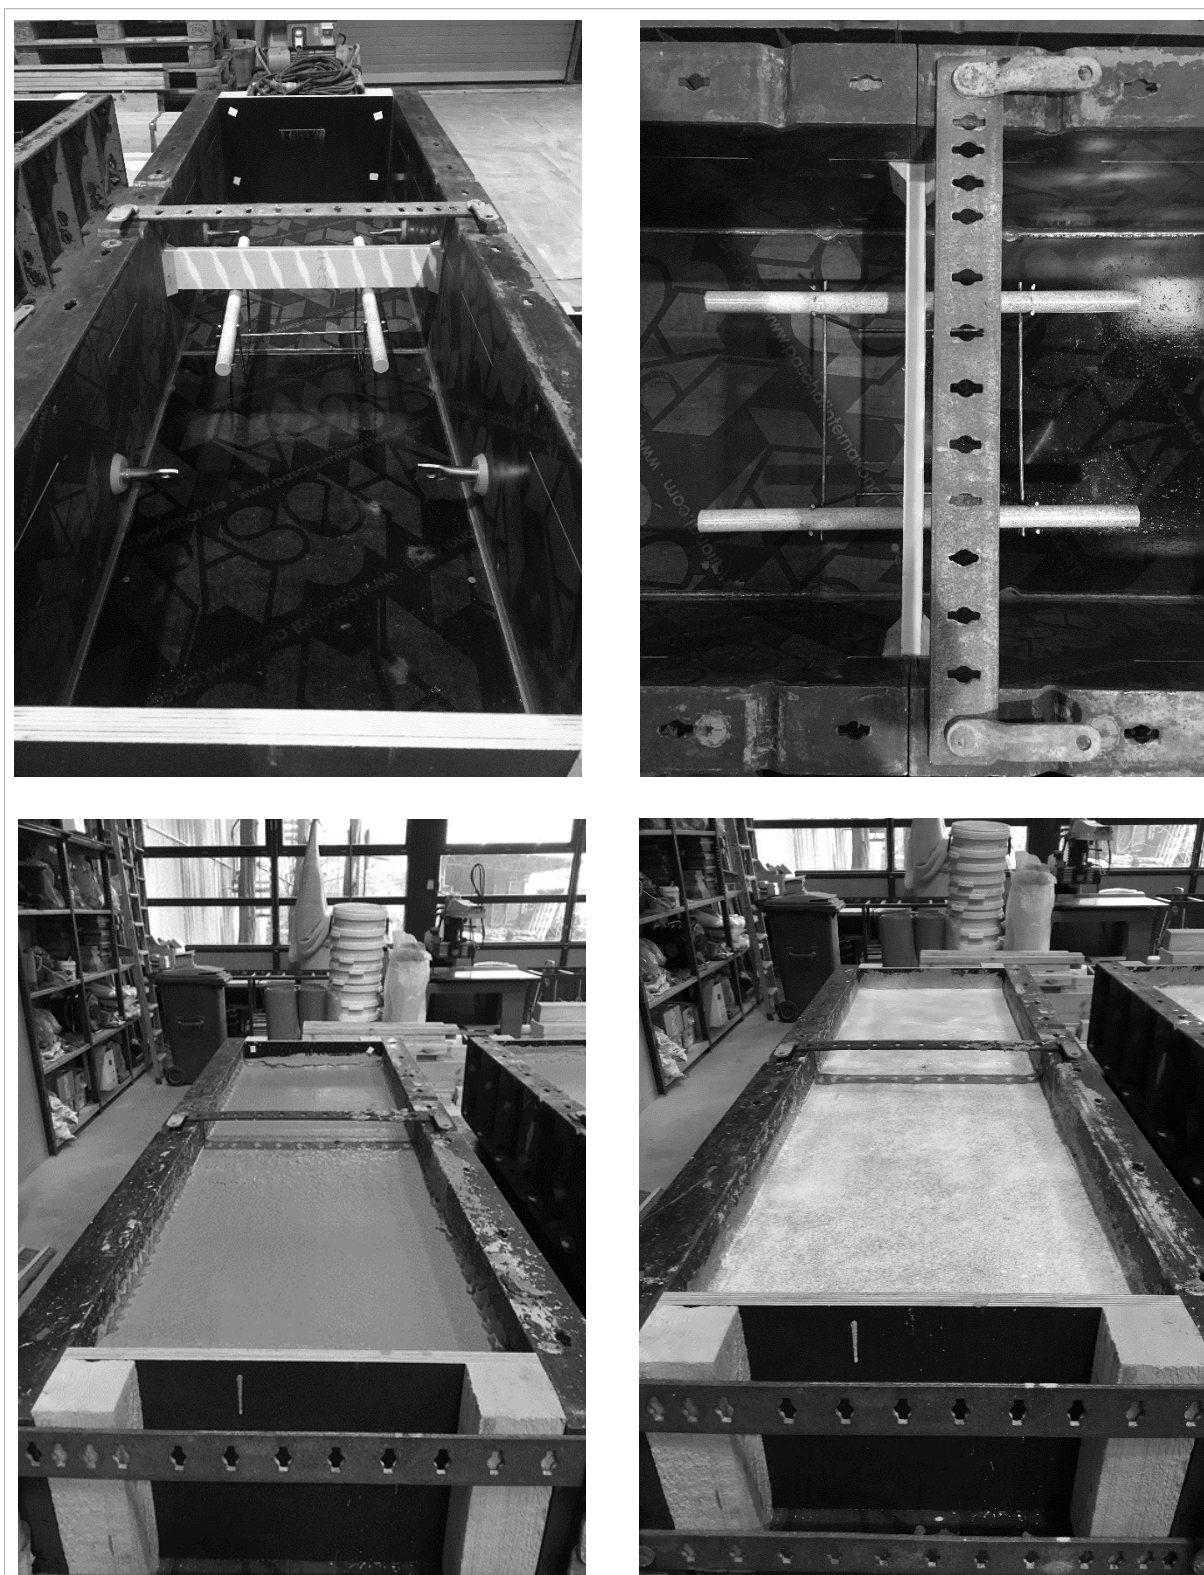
34: Herstellung der Unterbetonschichten. Oben links – Schalung mit Einbauteilen, oben rechts – Einbauteile in der Aufsicht, unten links – eingefüllter Beton, unten rechts- auf Betonoberfläche aufgetragene Oberflächenverzögerer zur Freilegung der Gesteinskörnung durch Auswaschen.
